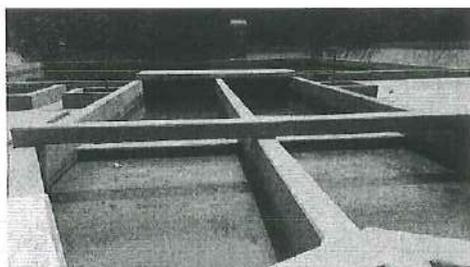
Vista del desarenador de la planta de recuperación de agua filtrada.
